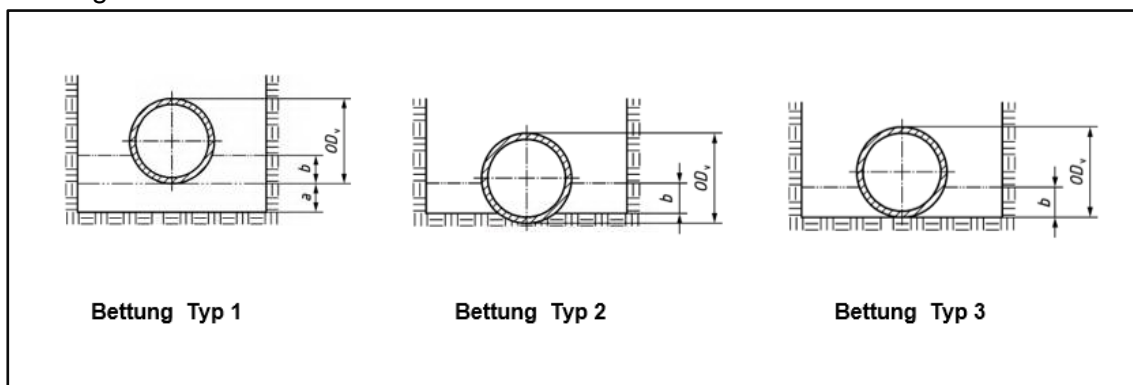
Rohrbettungstypen nach DIN EN 1610
